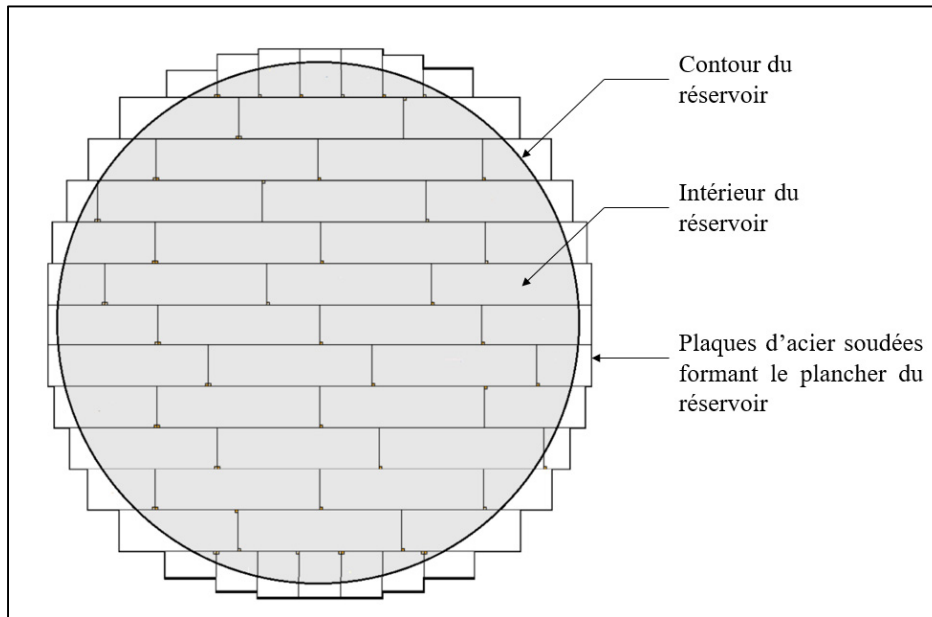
Schéma d'un plancher de réservoir industriel formé de plaques d'acier rectangulaires soudées
